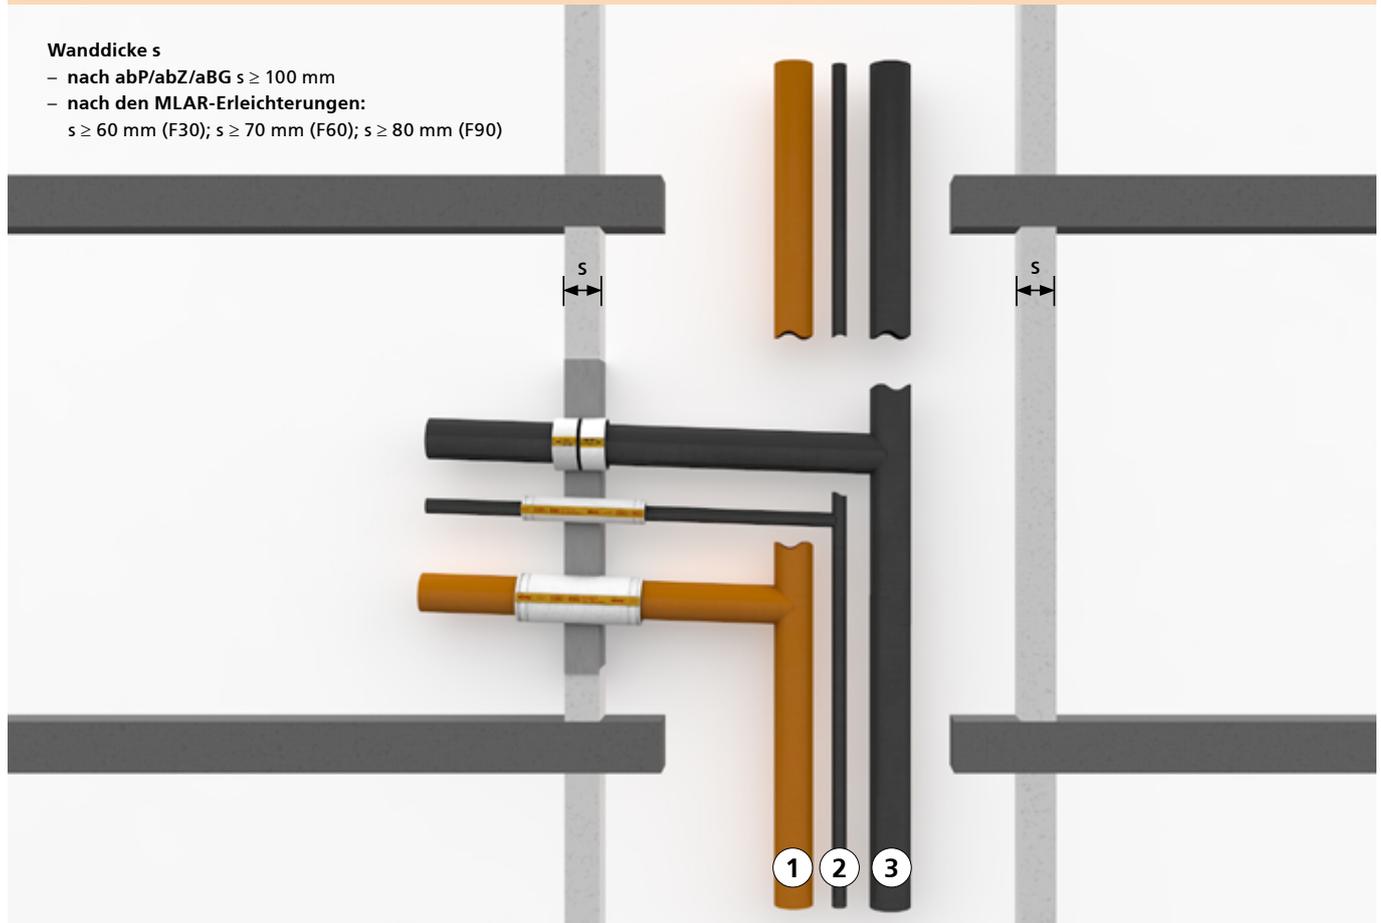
Durchführung von Sanitär- und Heizungsleitungen durch F90-, F60- und F30-Wände bzw. durch F90-, F60- und F30-Wände von Installationsschächten ohne Deckenverguss
